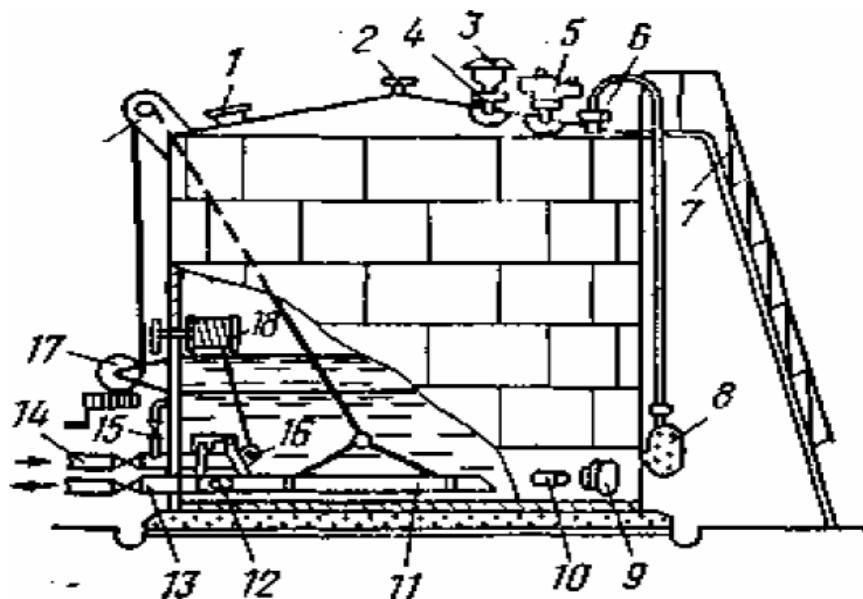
Схема расположения оборудования стальных вертикальных цилиндрических резервуаров
